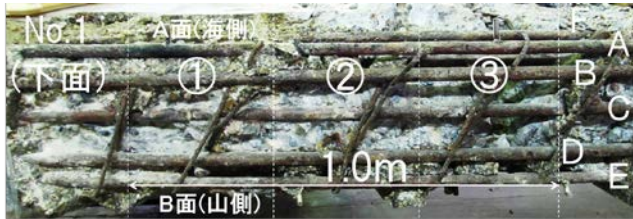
主鉄筋の腐食状態 (No.1支間中央部下面)
